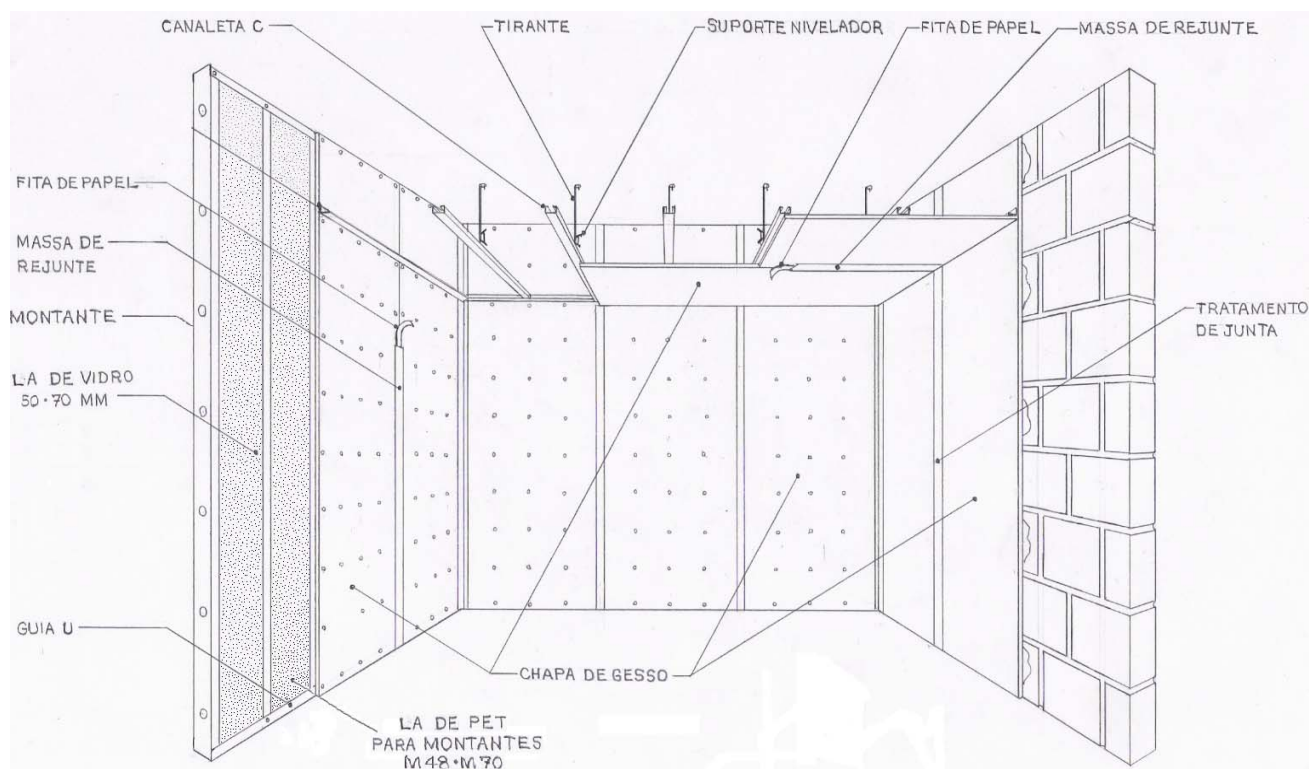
Ilustração do sistema construtivo em chapas de gesso para drywall
